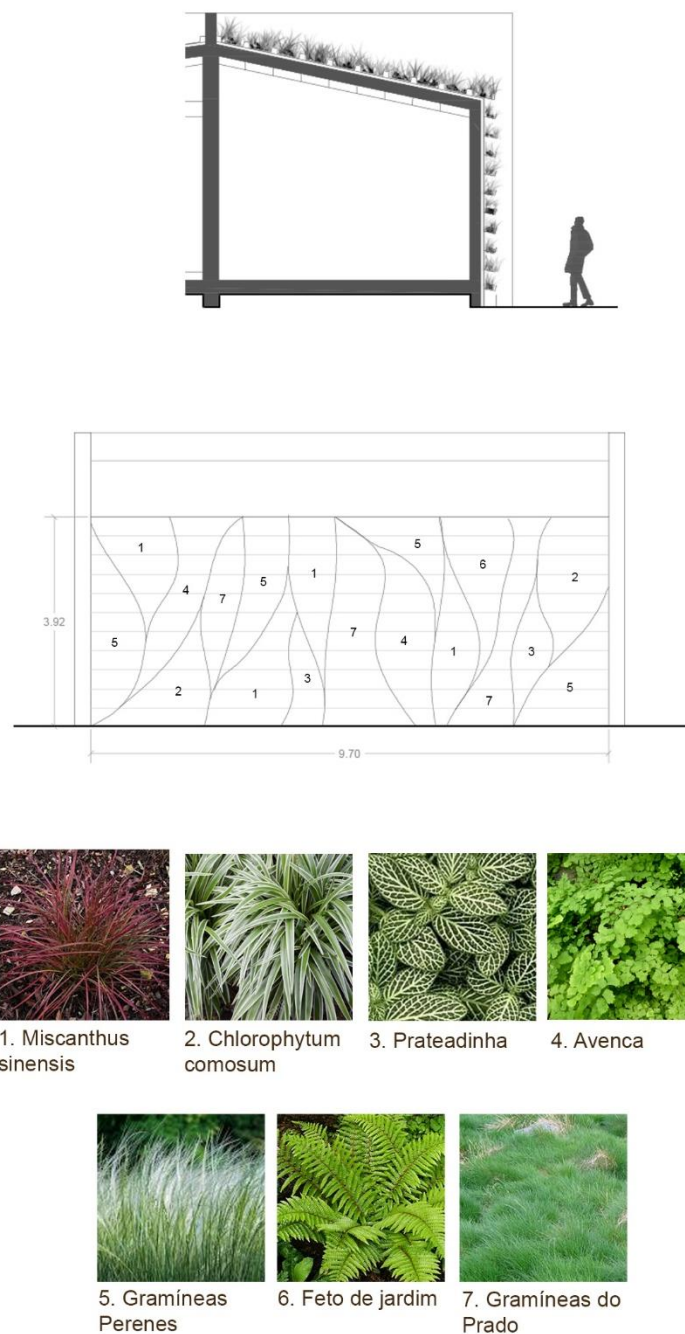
Corte e Alçado, composição da fachada verde, no âmbito de PFM, 2020.
